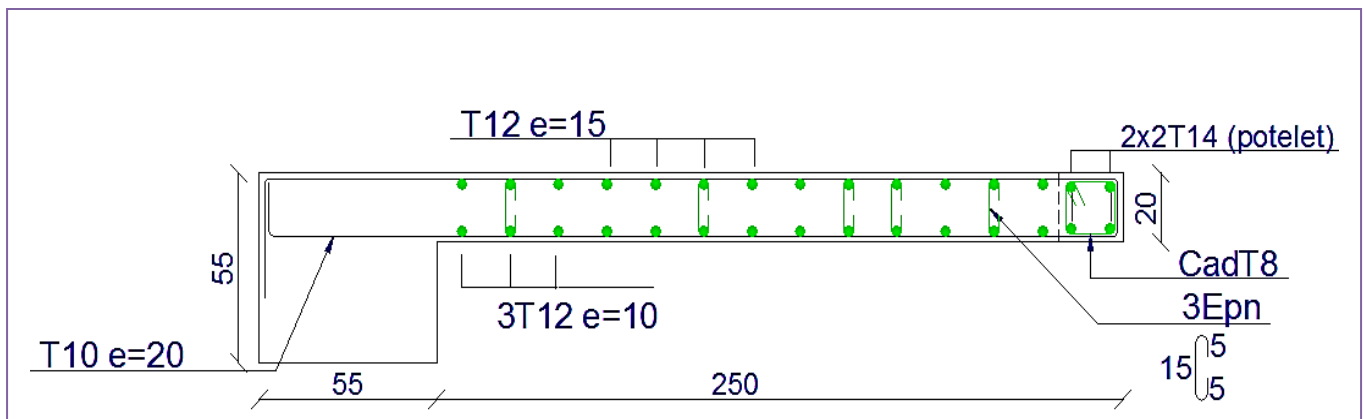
Schéma de ferrailage des voiles type V4 zone 1.
